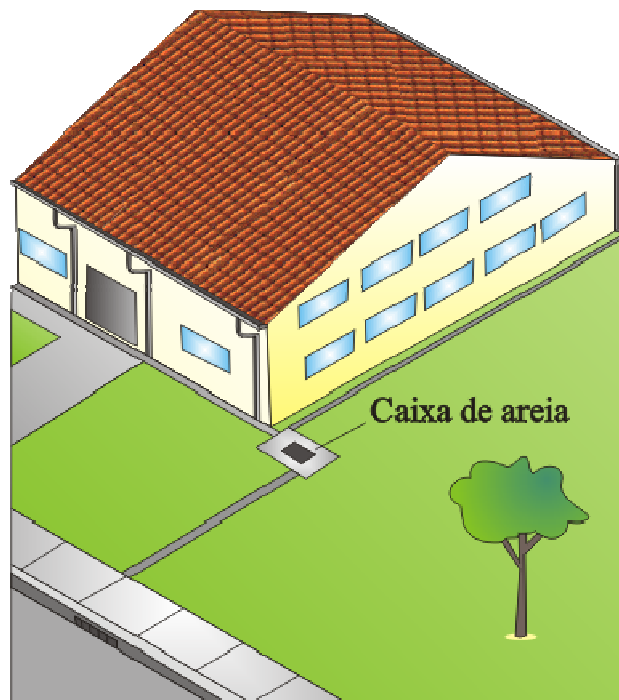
Detalhe geral do sistema de coleta de águas pluviais
